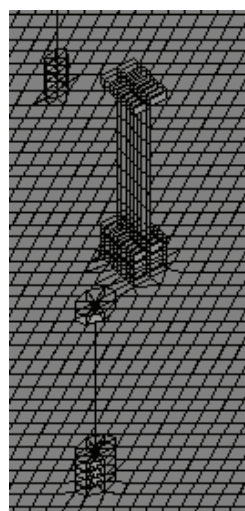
Применение объемных конечных элементов в стенах и колоннах на уровне их соединения с перекрытиями и фундаментной плитой.
